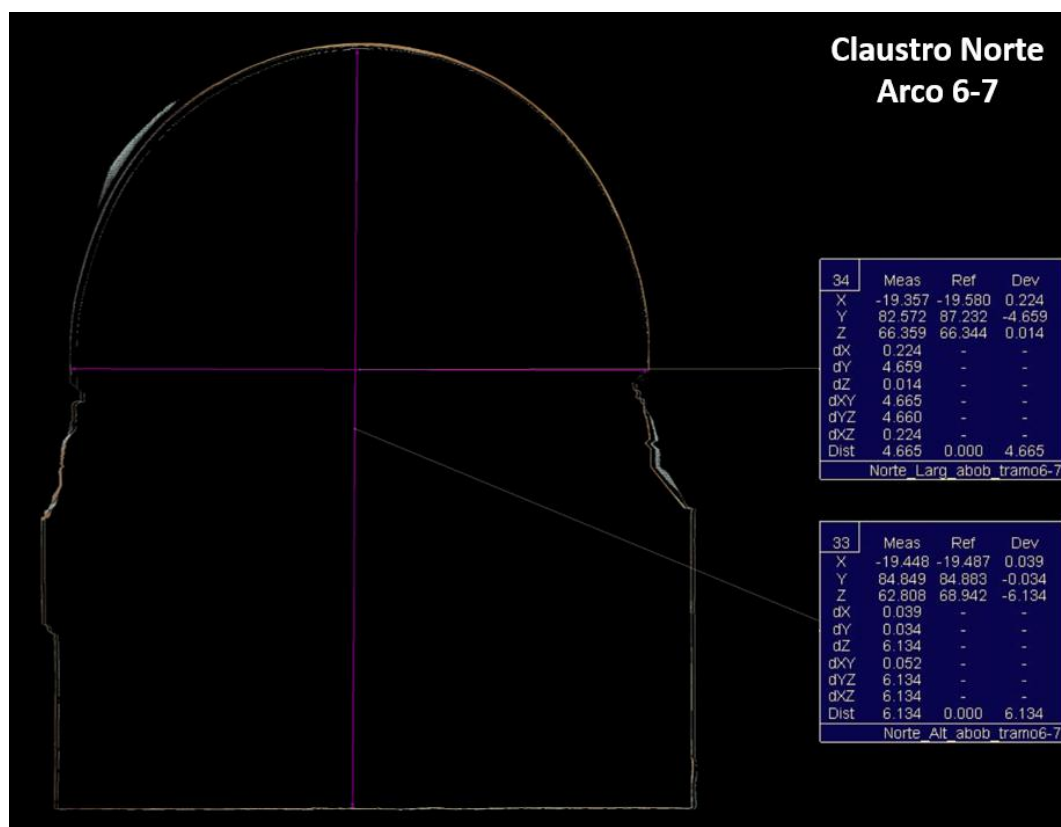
Corte transversal do Arco 6-7 do claustro Norte de D. Dinis.
